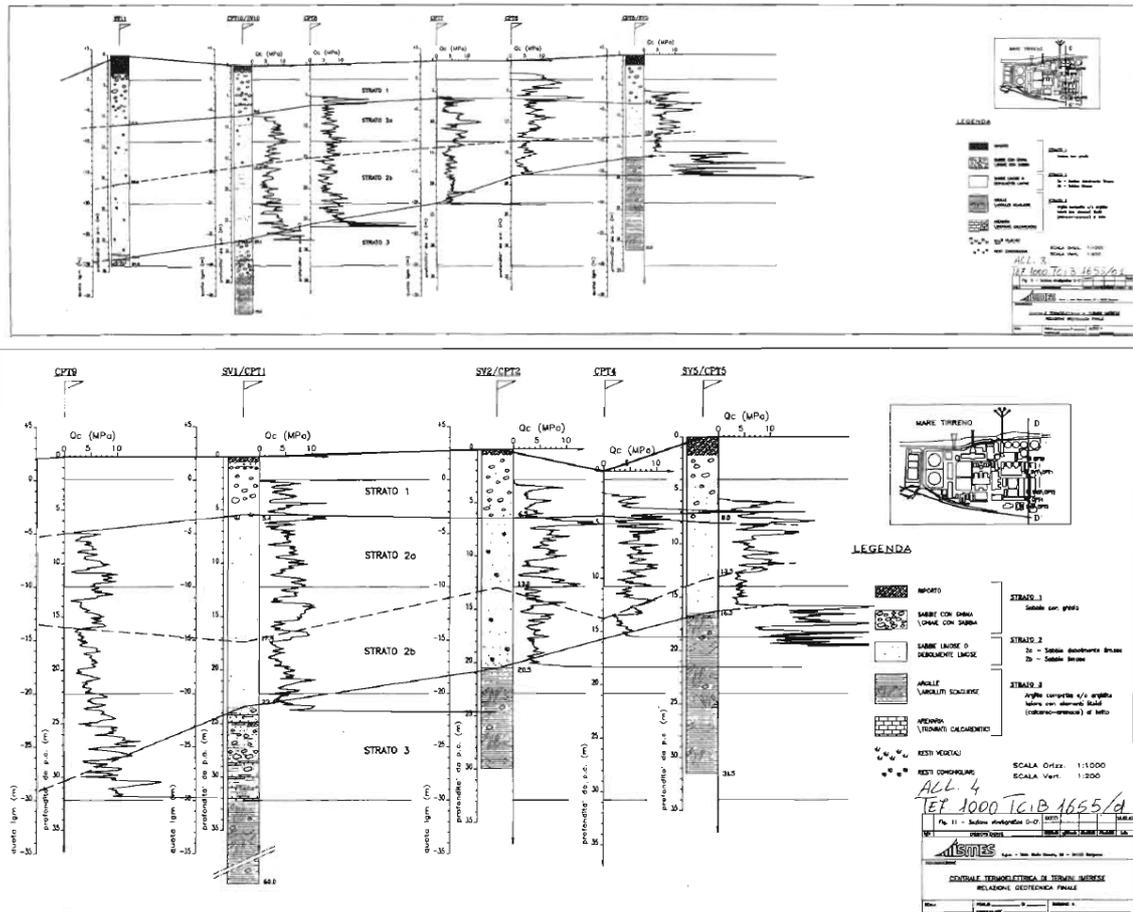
Planimetria indagine ISMES, sezione C-C e sezione D-D (da TE7.1000.TCIB.1655 "Centrale Termoelettrica di Termini Imerese – Relazione Geotecnica finale")
